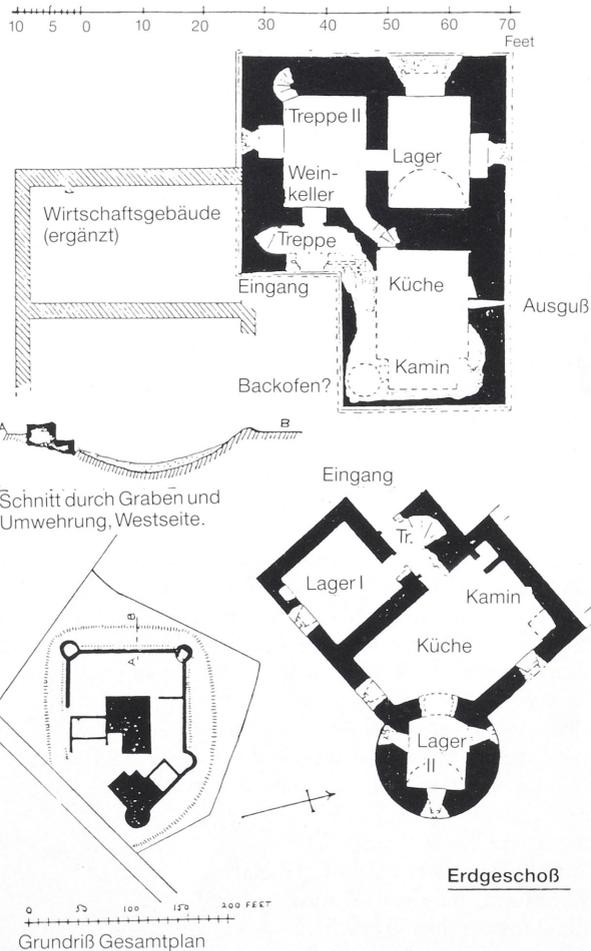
Esslemont Castle, Aberdeenshire (Typ L 3). Um 1600. Grabungsplan mit Grundrissen der beiden nebeneinander liegenden Wohntürme des späten 14. Jhs. (oben) und späten 16. Jhs. (Typ L 3; unten). W.D. Simpson, *The Excavation of Esslemont Castle, Aberdeenshire*, in: *PSAS* 78, 1943/44, Fig. 1, S. 103. Mit freundlicher Genehmigung der Society of Antiquaries of Scotland, Edinburgh.
